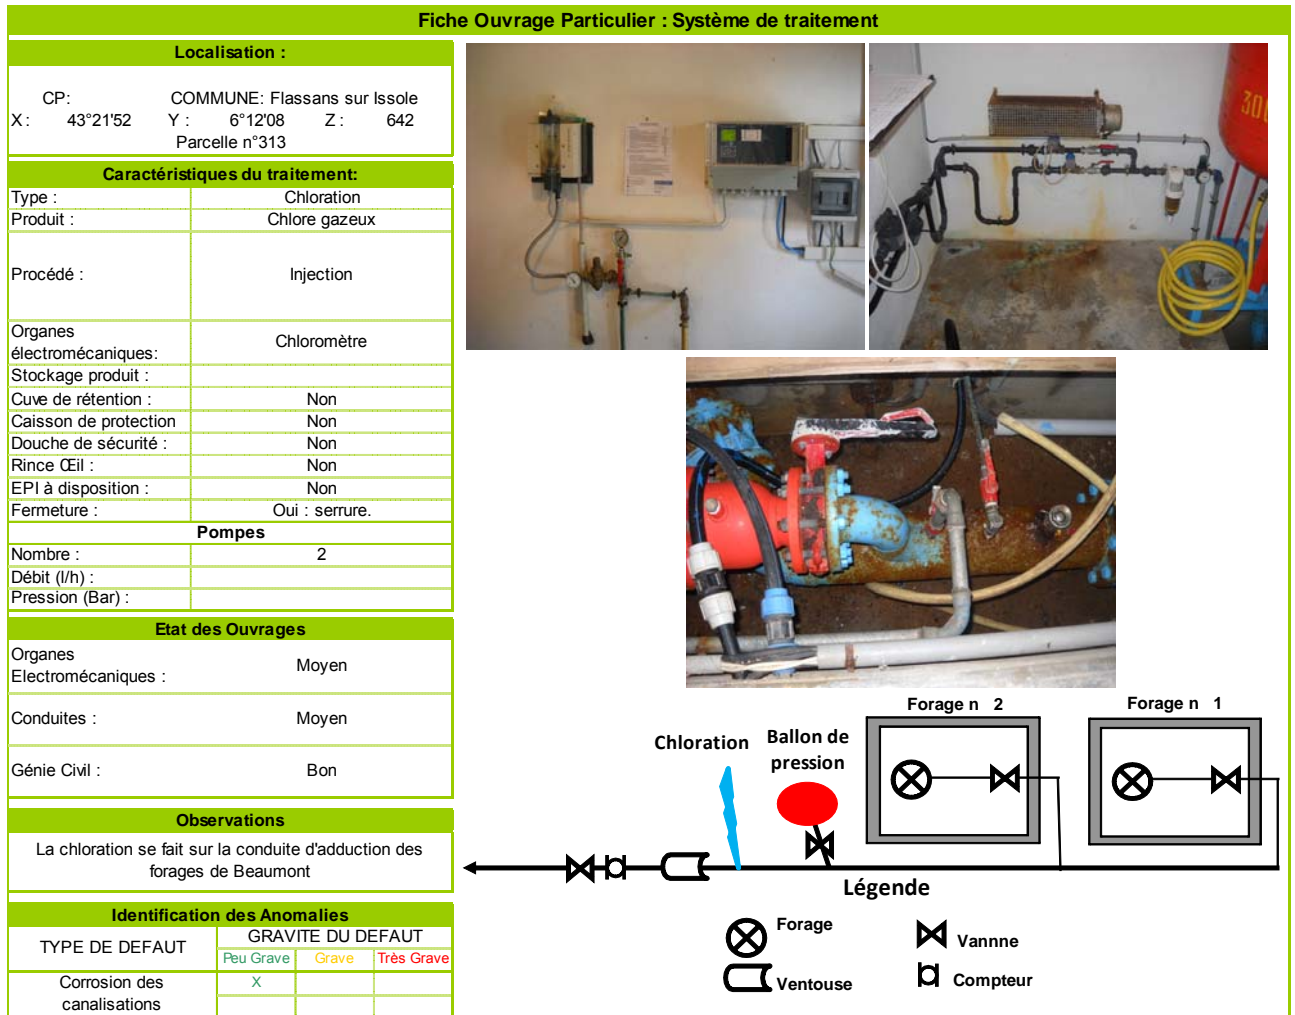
Fiche Ouvrage : Traitement Beaumont
